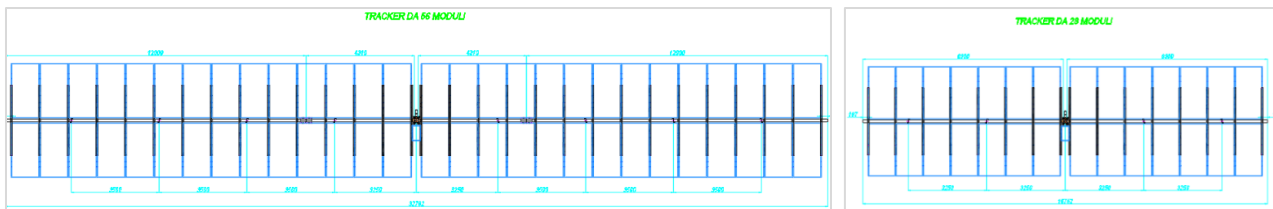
Configurazione Struttura tracker 2x28 e 2x14, vista in pianta
